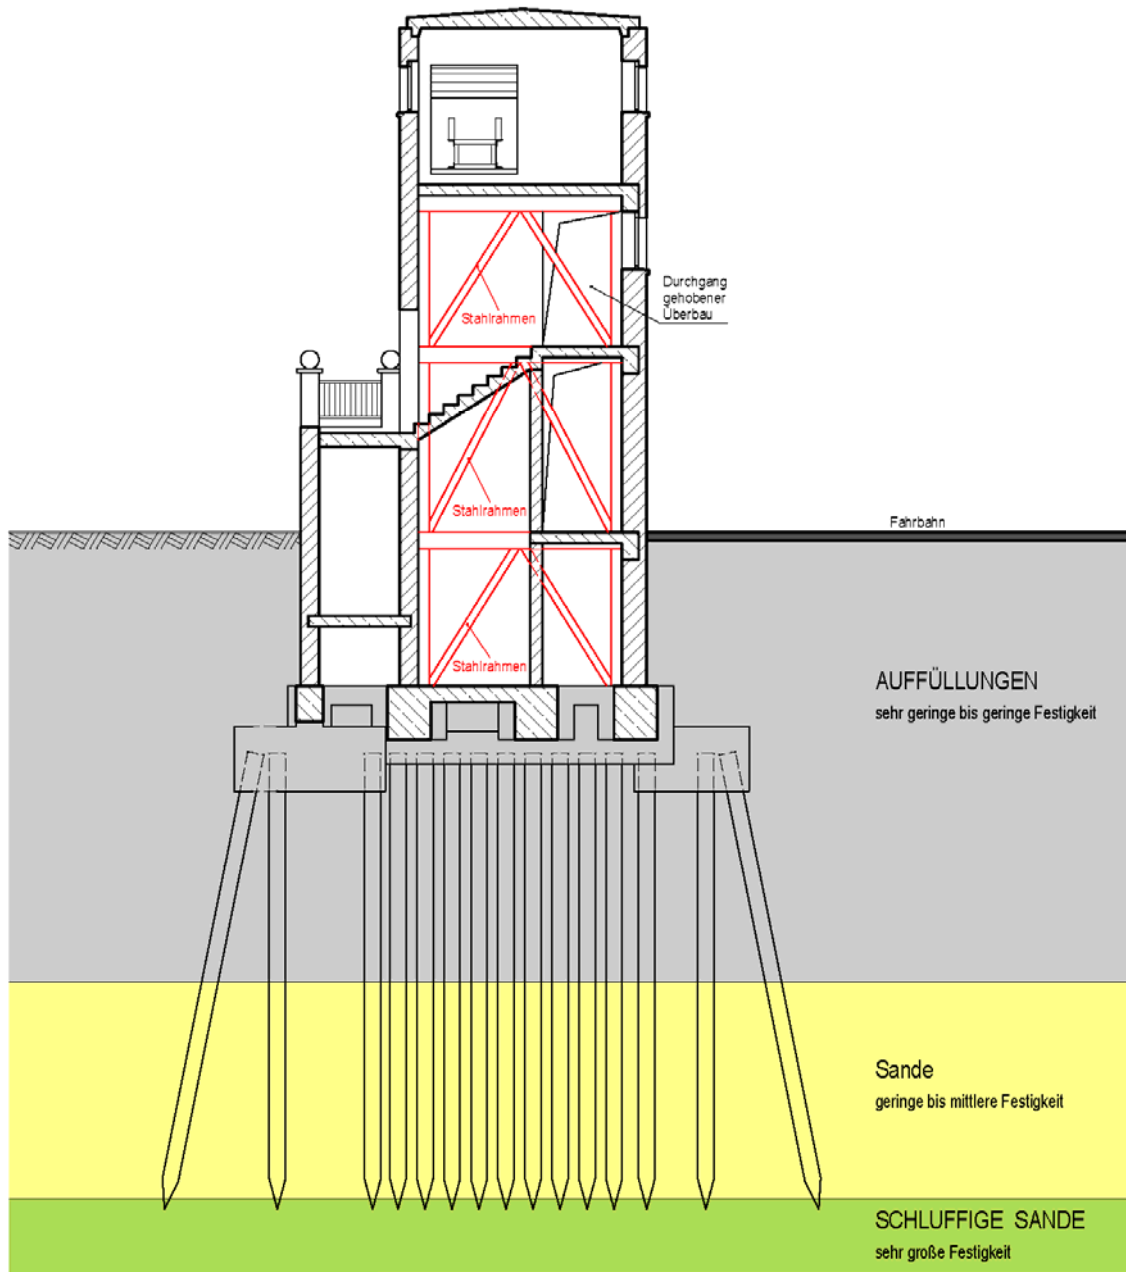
Turm mit innenliegender Stahlkonstruktion
